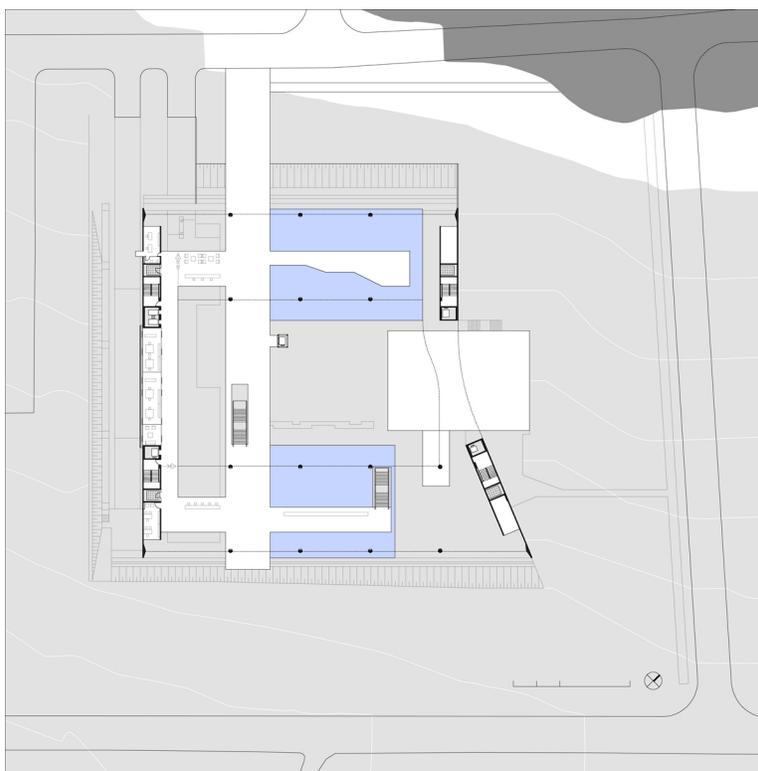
Sede do Sebrae: planta do pavimento térreo superior. Fonte: Puntoni et al. 2010
